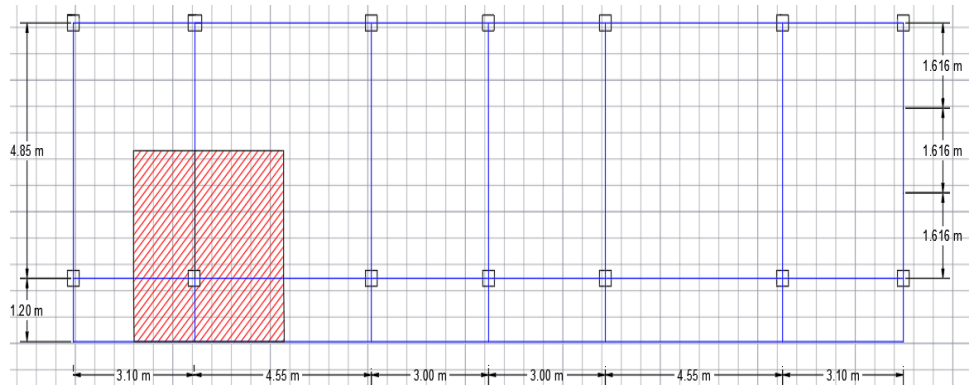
Área colaborante de la columna crítica de la estructura obtenida del plano arquitectónico.
